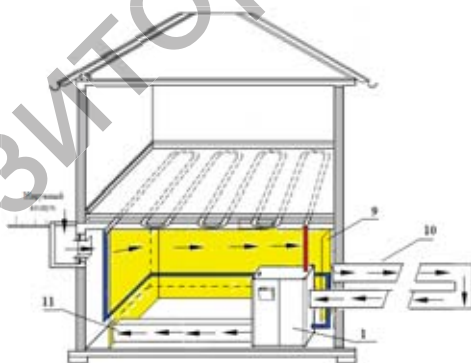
Принципиальная схема подогрева наружного воздуха, поступающего в ТНВХВ: 1 – тепловой насос ТНВХВ; 9 – воздухопровод подвального помещения; 10 – грунтовый воздухопровод; 11 – обратный воздух ТНВХВ
